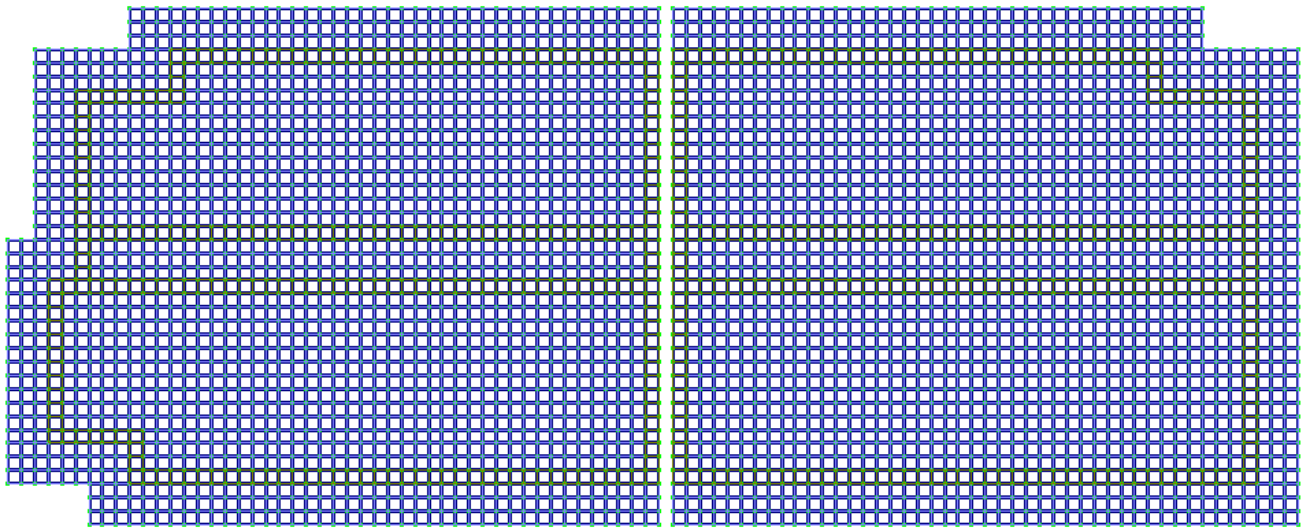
Розрахункова схема монолітної фундаментної плити перекриття
